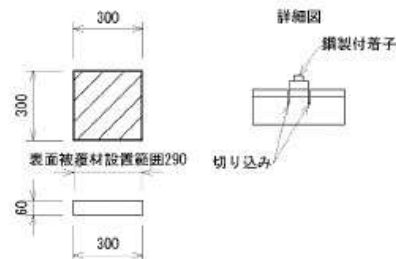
試験体の形状・寸法、試験方法の概要図
